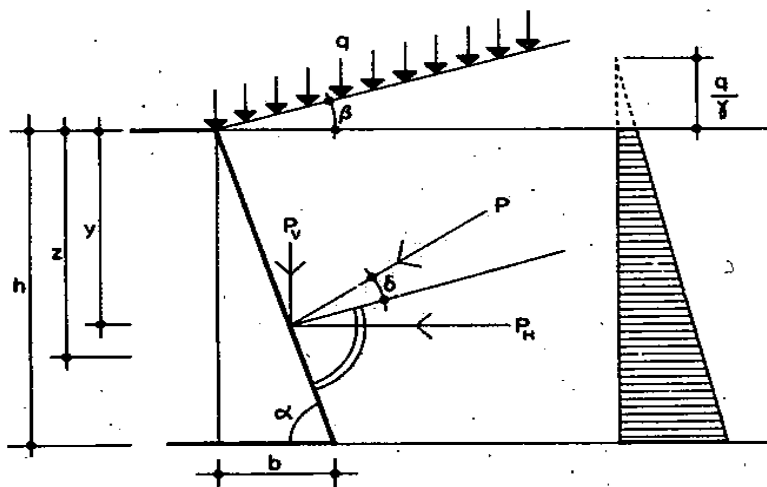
Croquis de un muro de trasdós plano.
